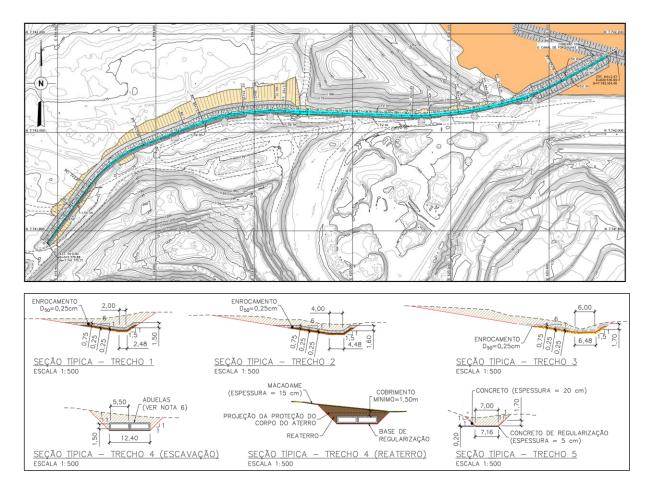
Canal de descaracterização de montante Planta e Seções típícas– Fonte 1850HH-X-X41378
